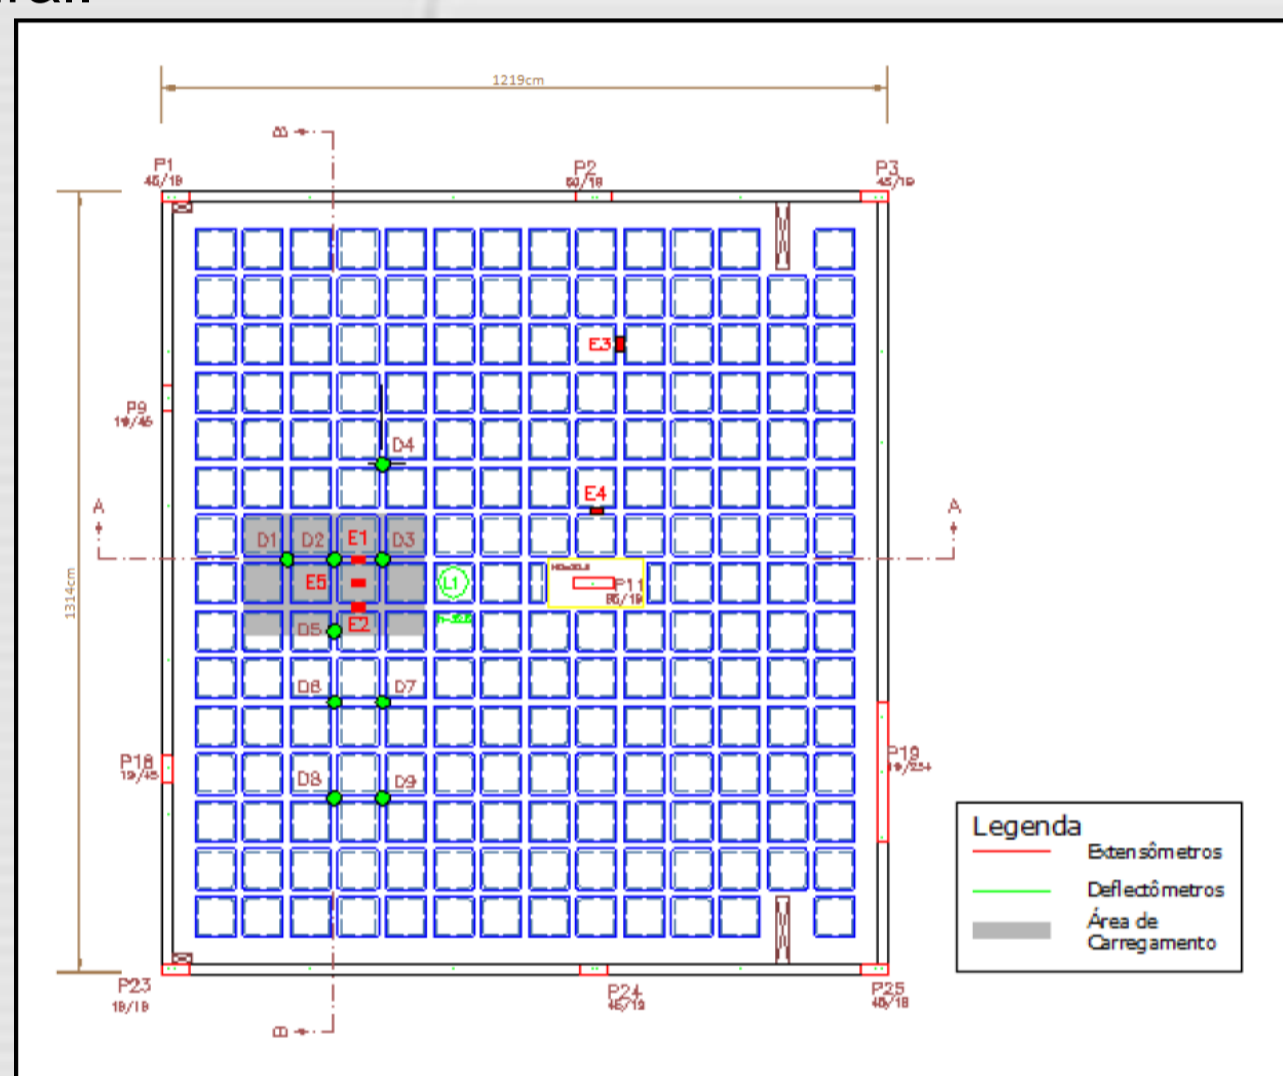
Planta e locação dos pontos de instrumentação da laje, área do carregamento uniforme e planos de corte "A" e "B" para análise dos resultados.
